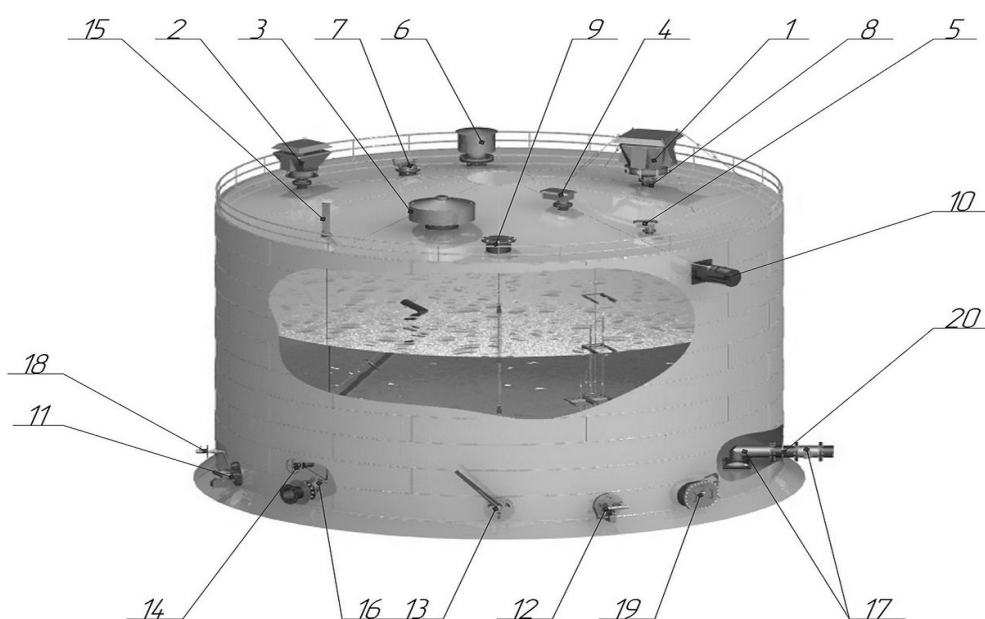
Оборудование резервуара 1 — клапан дыхательный совмещённый КДС, 2 — клапан дыхательный механический КДМ, 3 — клапан аварийный АК, 4 — совмещённый механический дыхательный клапан СМДК, 5 — клапан дыхательный механический КДМ-50, 6 — патрубок вентиляционный ПВ, 7 — люк замерный ЛЗ, 8 — люк монтажный ЛМ, 9 — люк световой ЛС, 10 — генератор пены средней кратности ГПСС, 11 — пробоотборник плавающий резервуарный ПП, 12 — пробоотборник стационарный резервуарный органного типа ПСР ОТ, 13 — пробоотборник стационарный секционный резервуарный ПСР, 14 — механизм управления хлопушкой боковой МУ-1, 15 — механизм управления хлопушкой верхней МУВ, 16 — хлопушка ХП, 17 — приёмораздаточное устройство ПРУ, 18 — кран сифонный КС, 19 — люк-лаз ЛЛ, 20 — приёмораздаточный патрубок ПРП.
